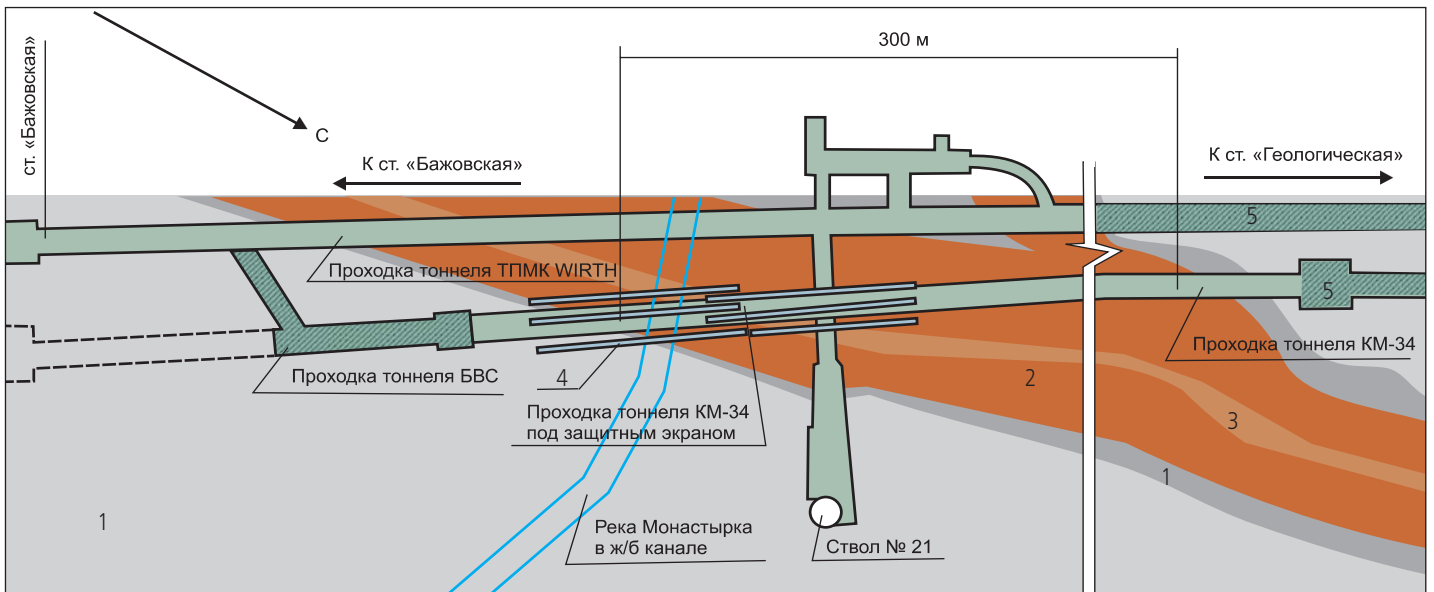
План расположения горных выработок на пересечении участка слабых пород: 1 – скальные грунты различной прочности; 2 – суглинки; 3 – супеси; 4 – грунтоцементные сваи; 5 – выработки, пройденные перед началом проходки неблагоприятного участка ППТ
